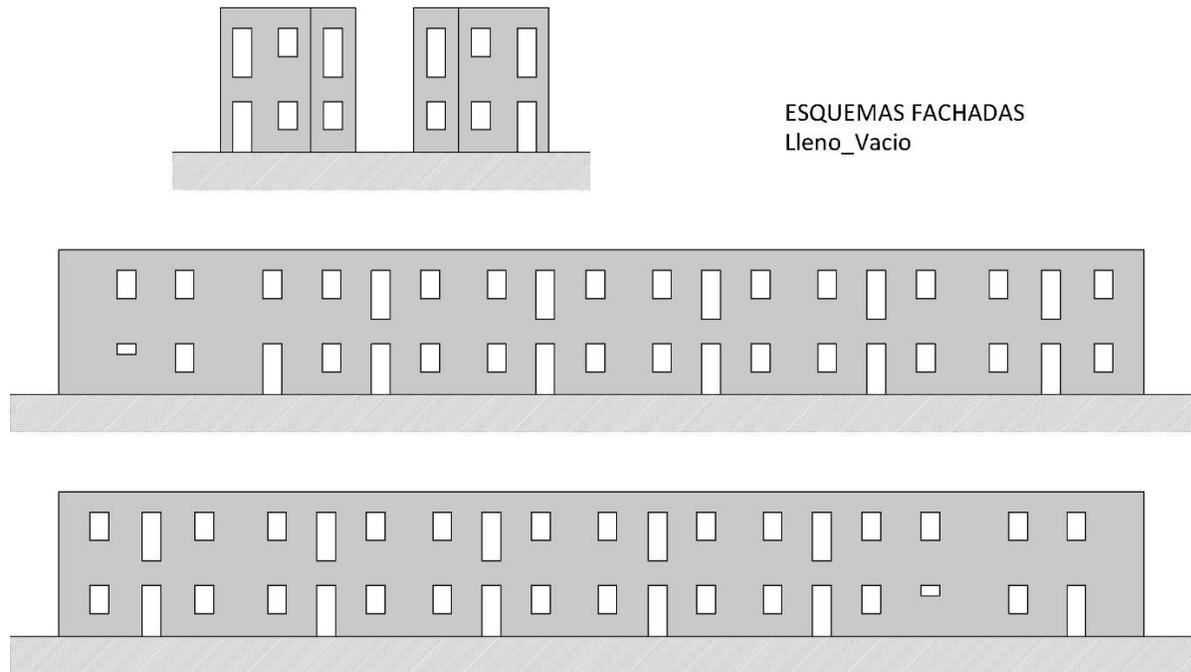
Esquema de fachadas consideradas para el cálculo de porcentajes.
